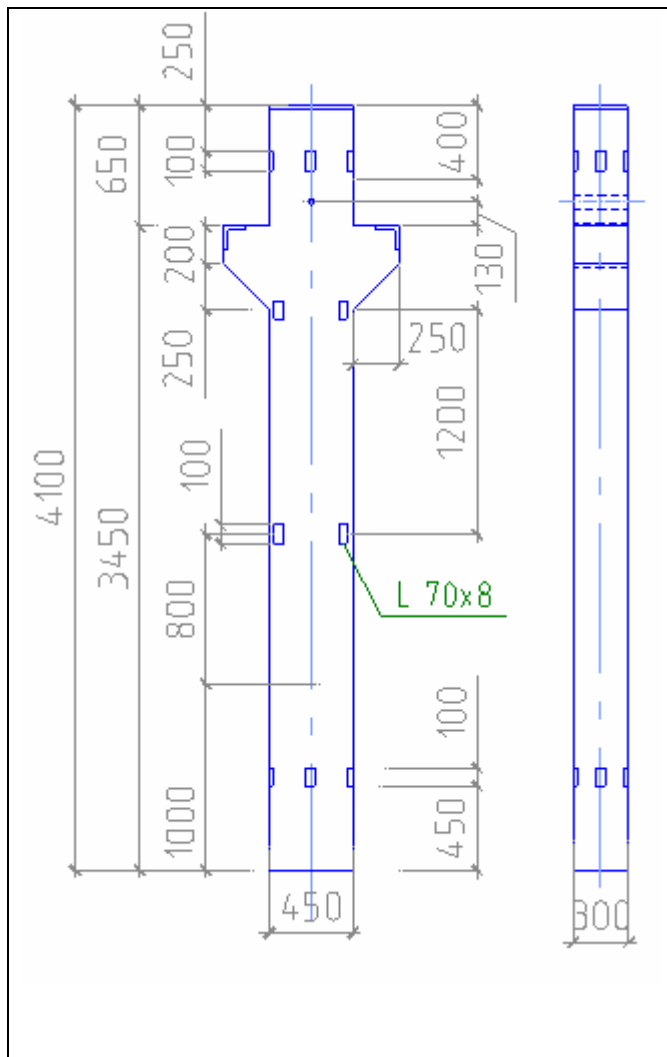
Опалубочная схема колонны НК10-1
